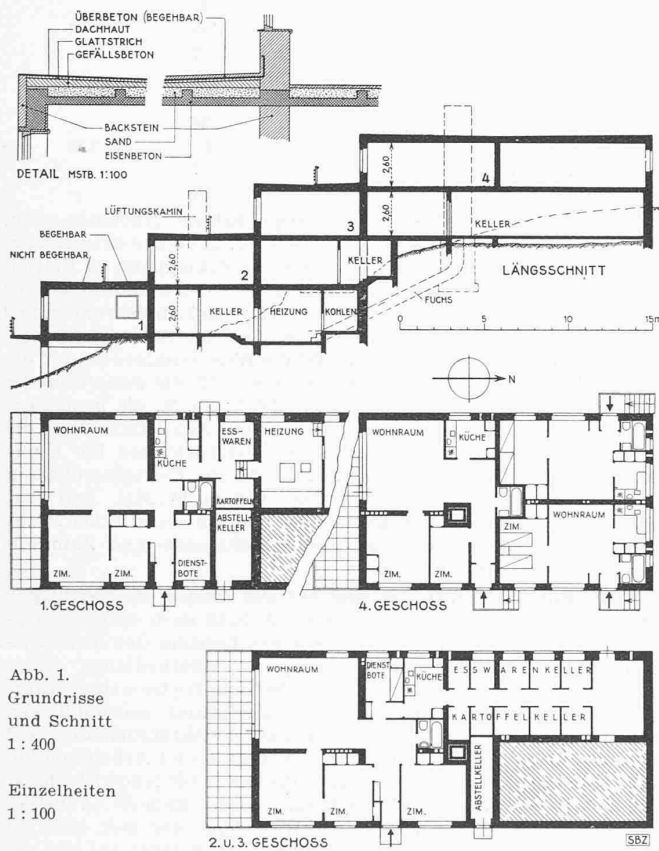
Grundrisse und Schnitt 1:400
